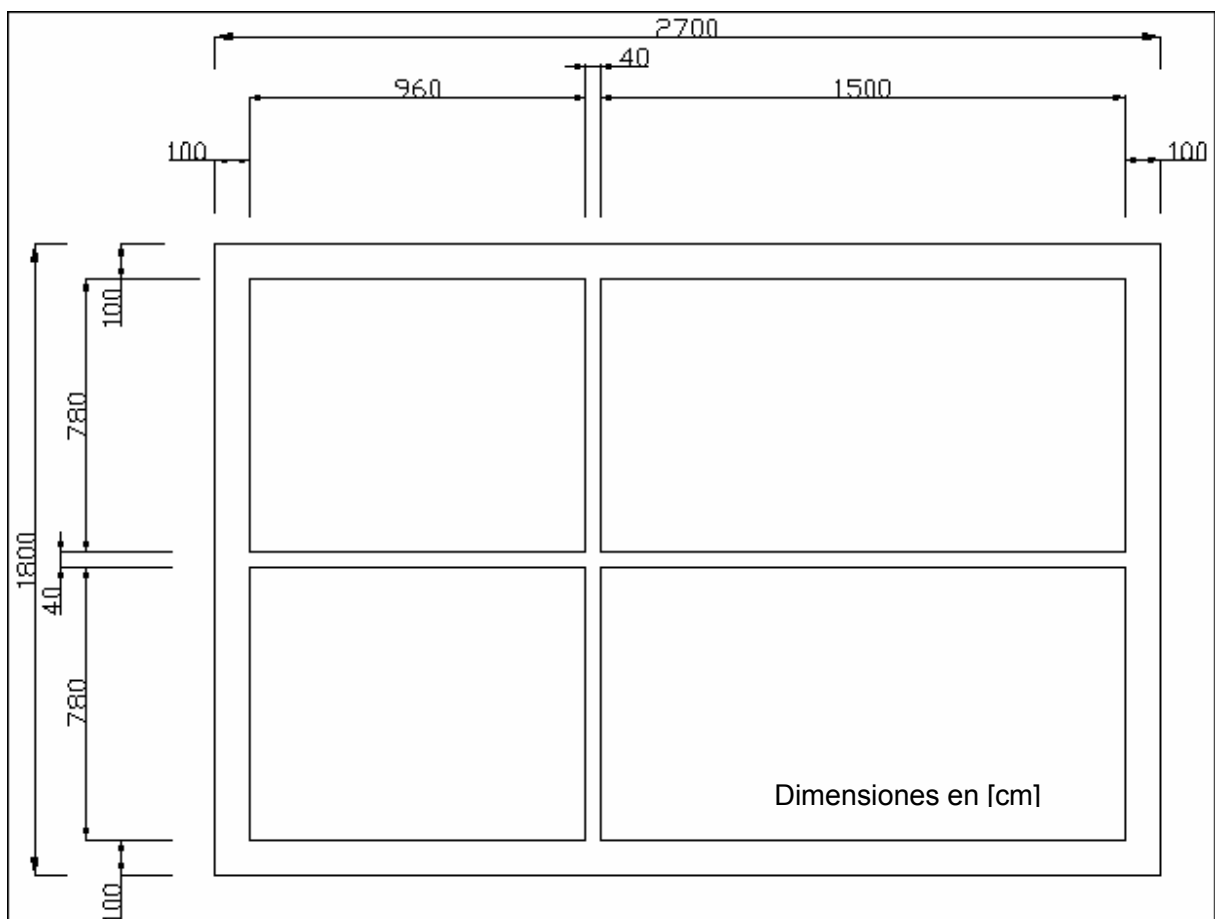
Planta tipo de caja de ascensores de edificio supuesto.
